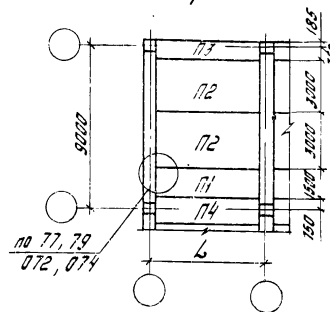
Типовые раскладки ребристых плит перекрытия и покрытия серии 1.042-1
